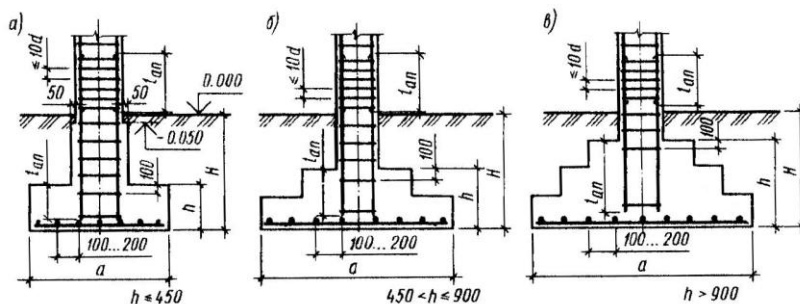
Поперечный профиль и армирование монолитных отдельных фундаментов под колонны: а – одноступенчатый фундамент с подколонником; б, в – двух- и трехступенчатые фундаменты
